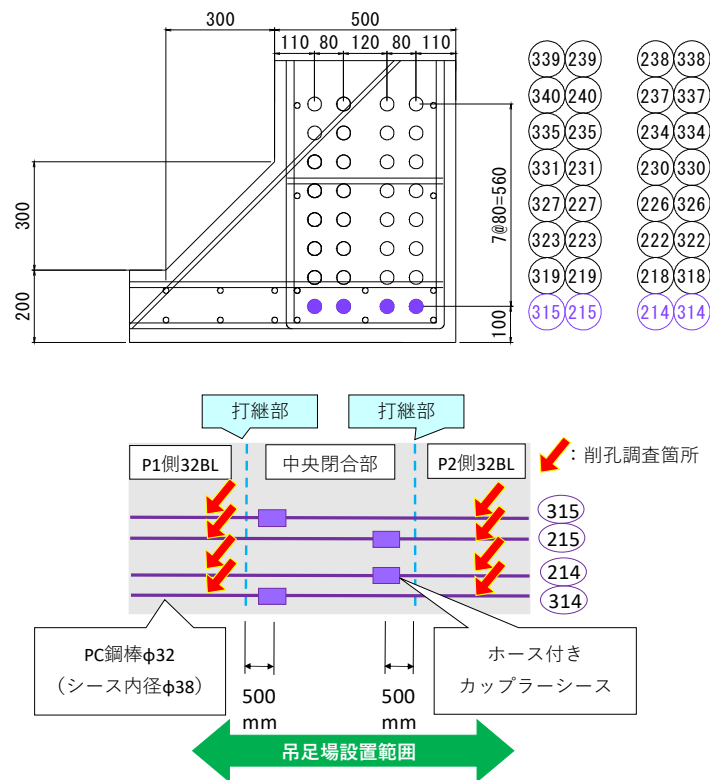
一次調査の対象としたPC鋼棒 上：断面図 下：平面図
